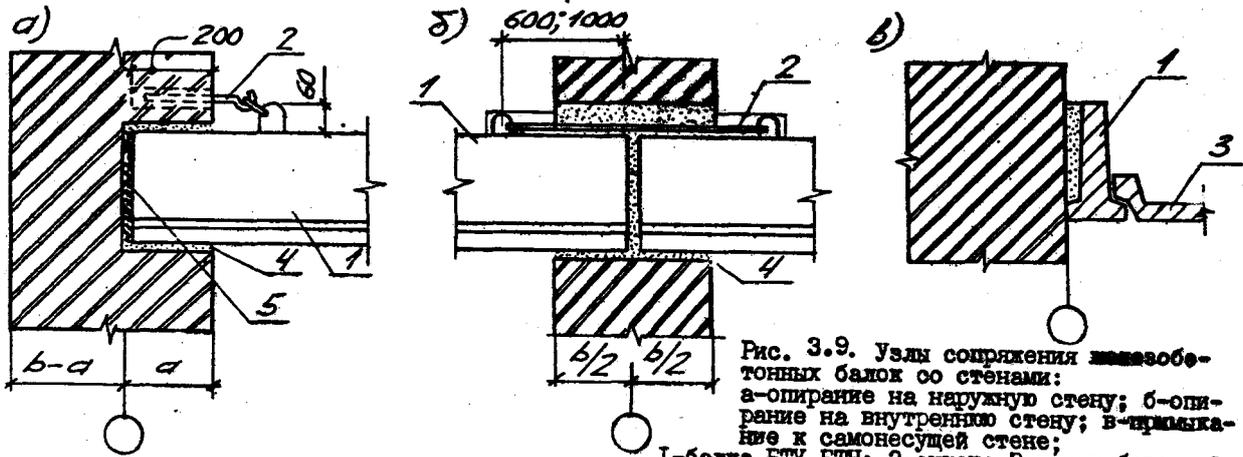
Узлы сопряжения железобетонных балок со стенами: а-опирание на наружную стену; б-опирание на внутреннюю стену; в-примыкание к самонесущей стене; 1-балка БТУ, БТН; 2-анкер; 3-железобетонный вкладыш; 4-цементный раствор; 5-минеральный вкладыш
